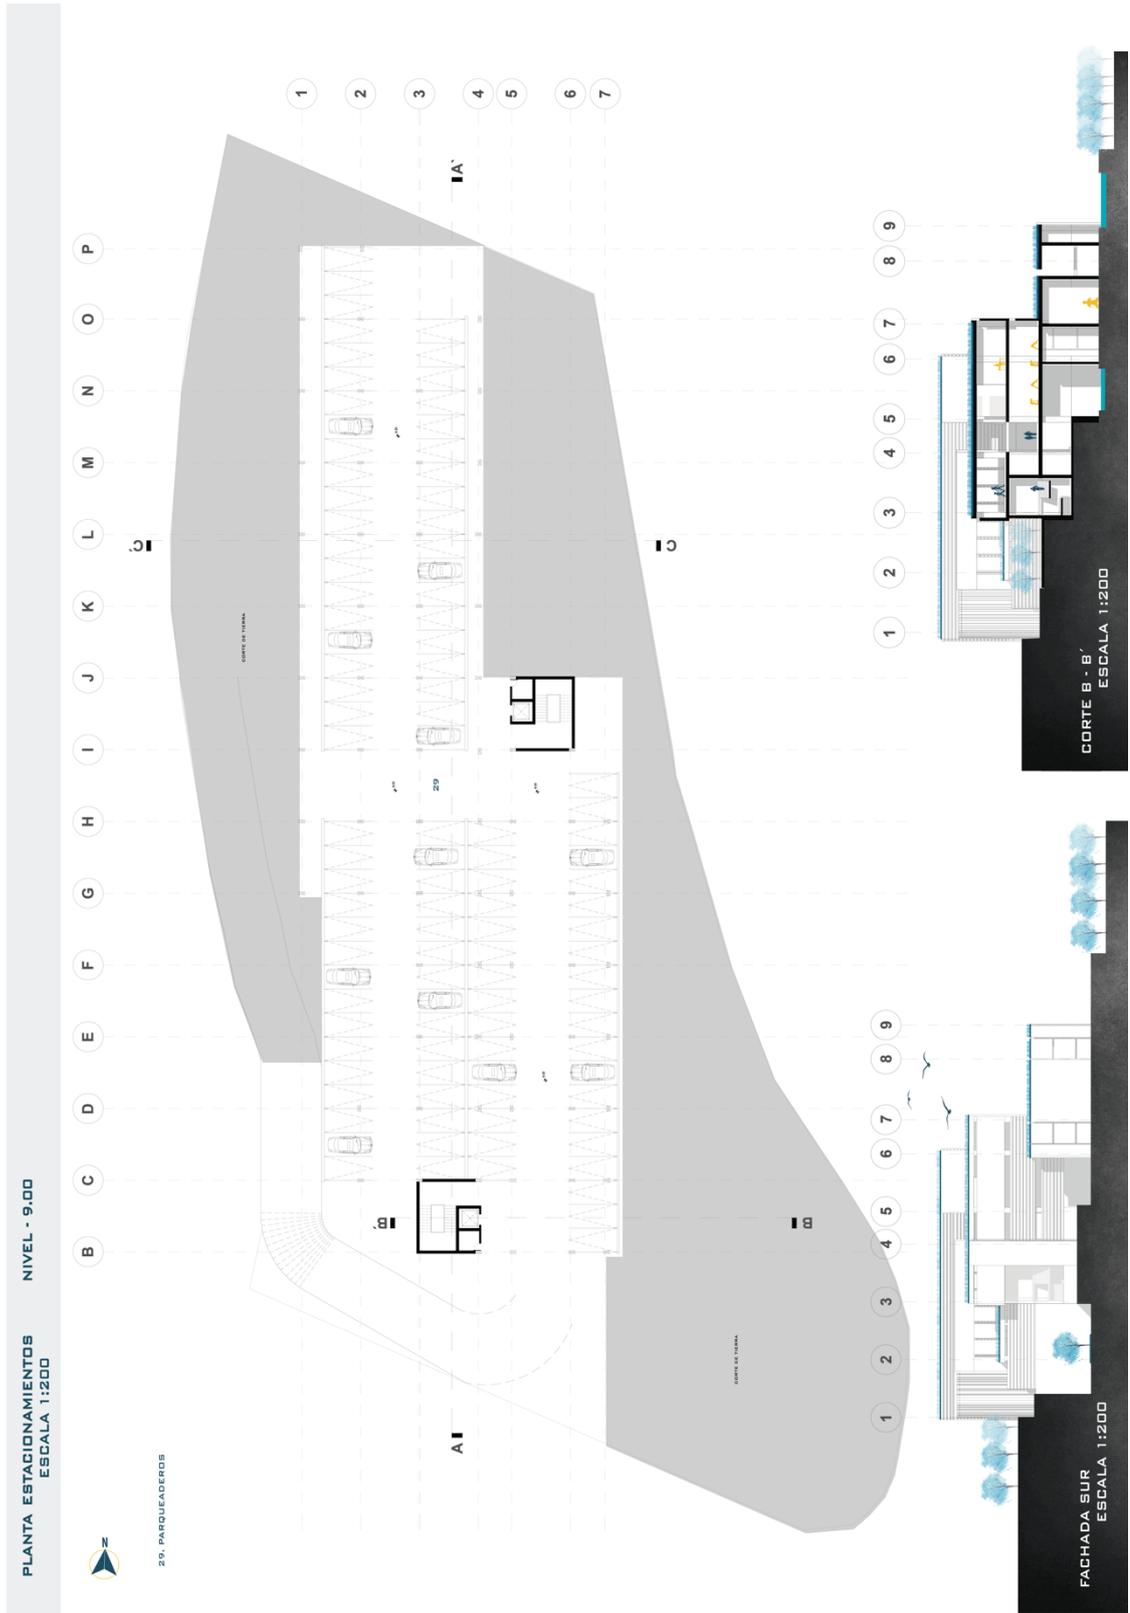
Planta Estacionamientos / Corte B-B' / Fachada Sur . (Elemento Propio)
